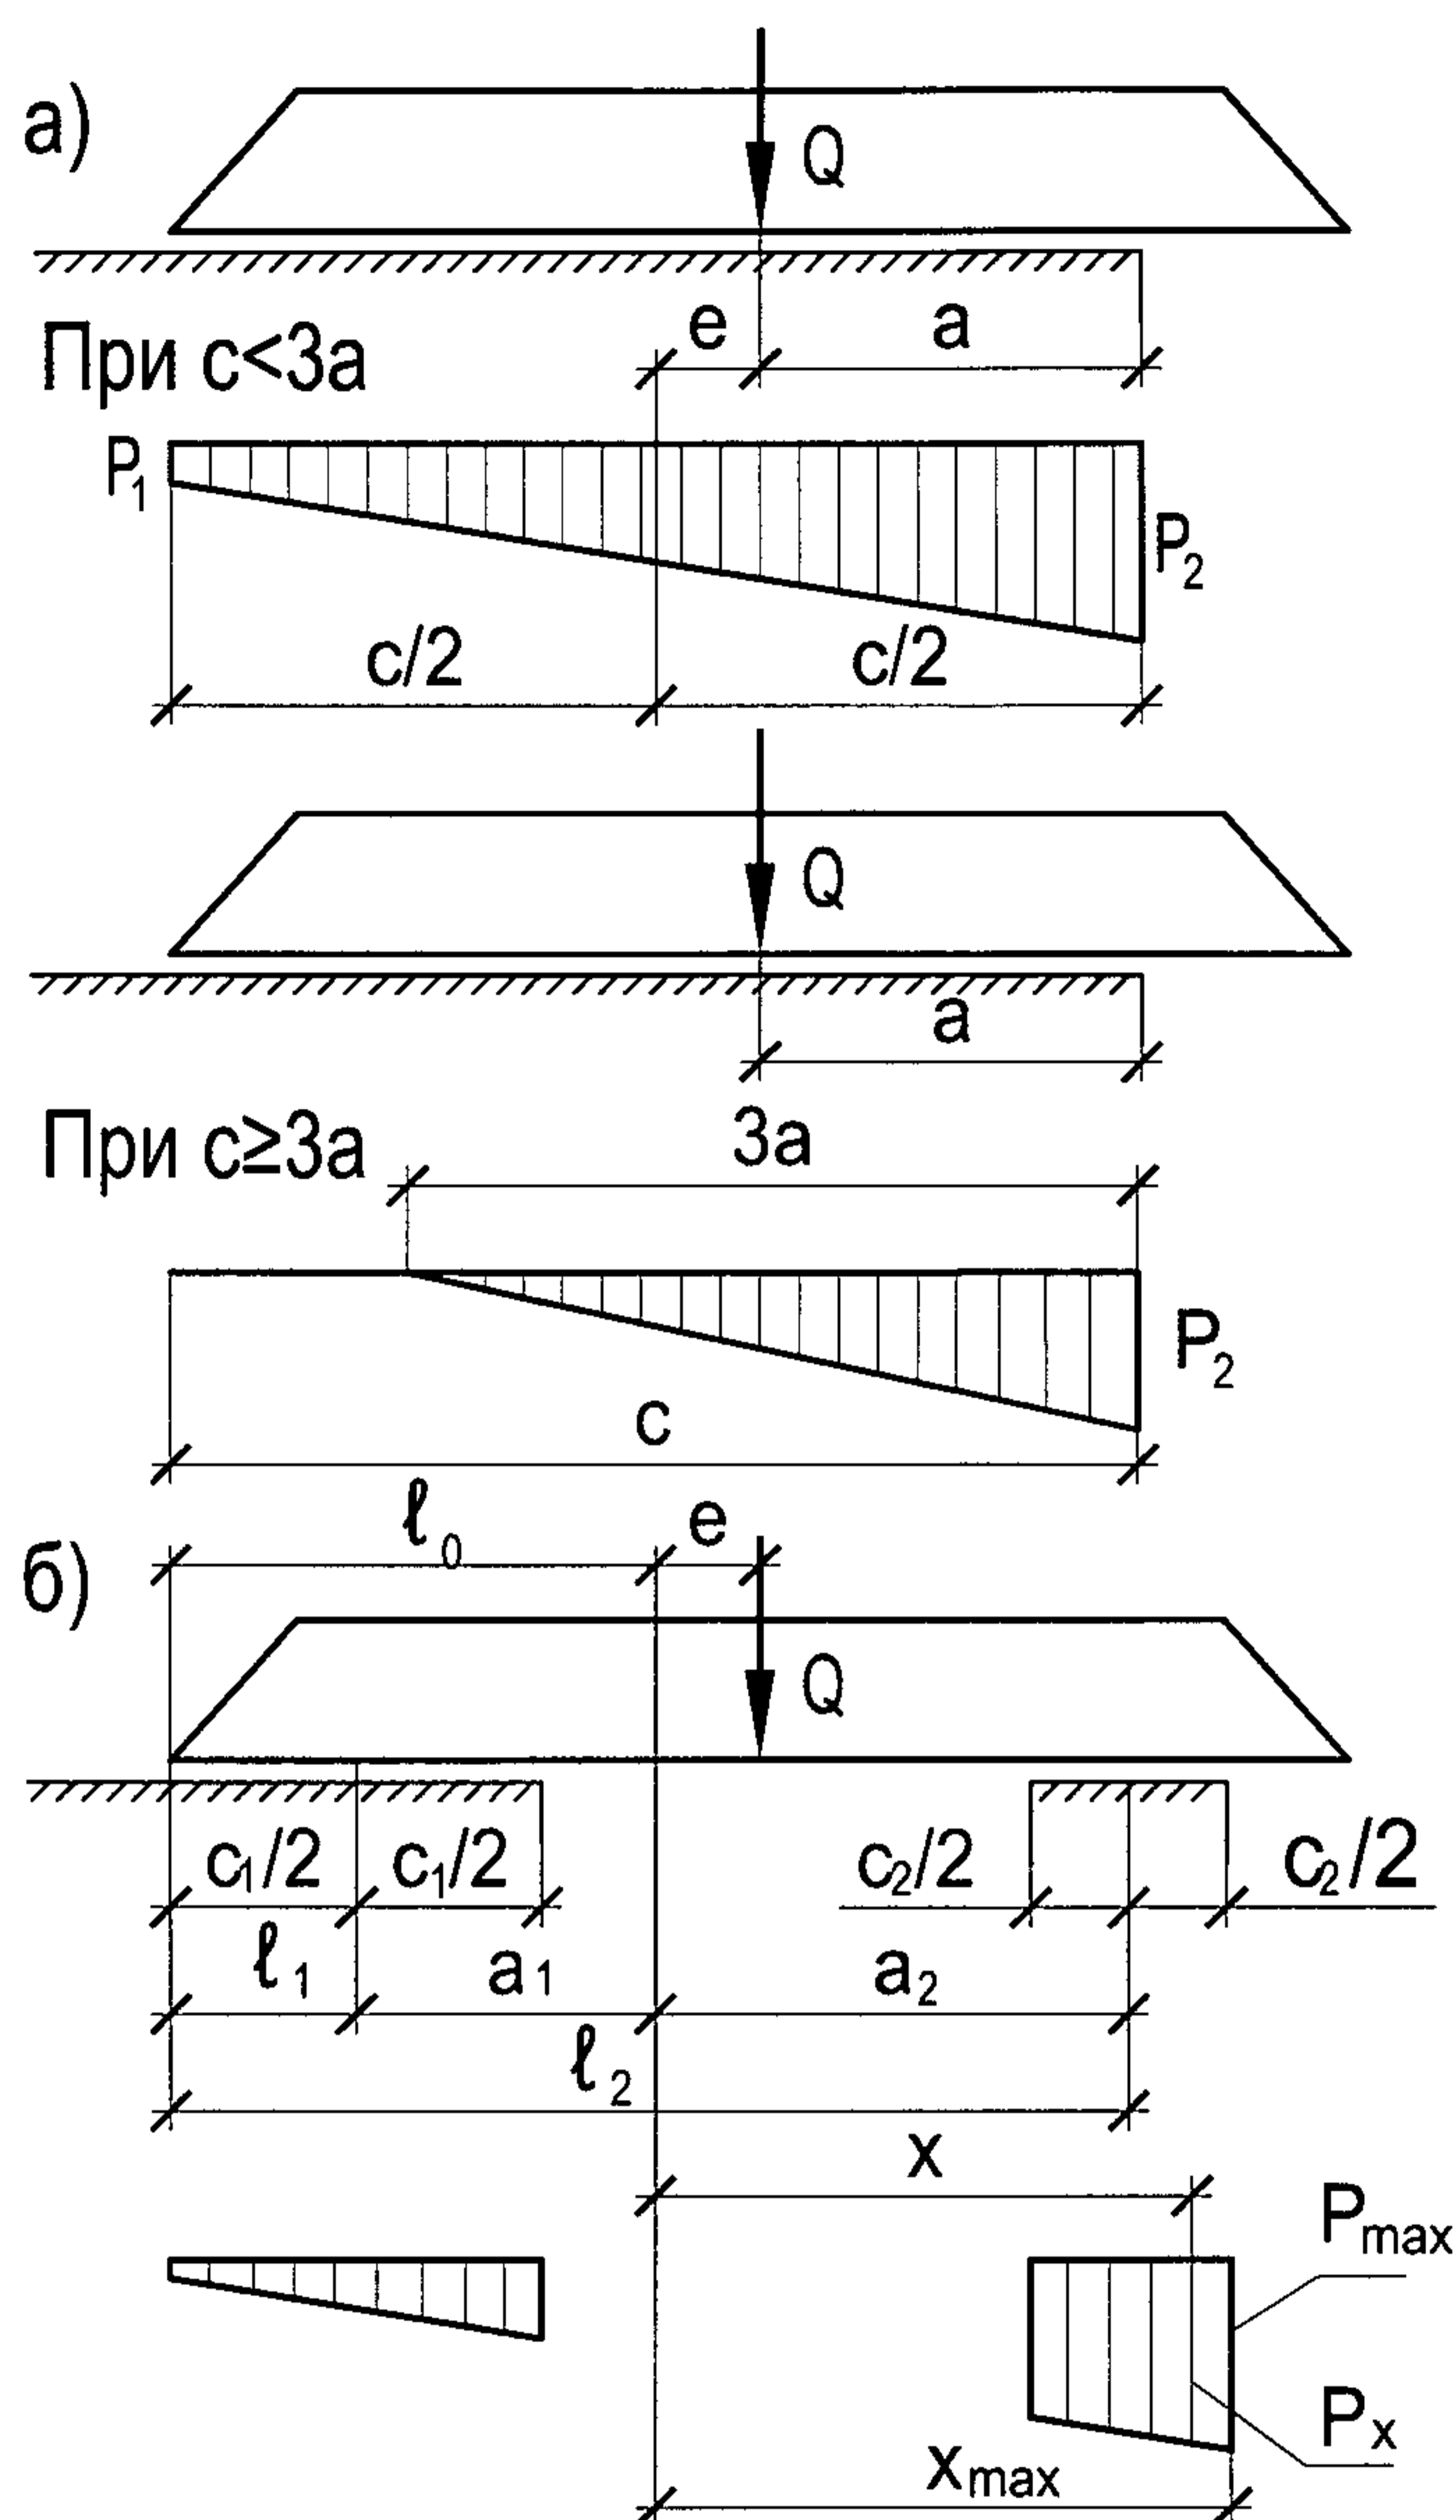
Расчетные схемы нижнего накаточного пути при продольной перекатке.
